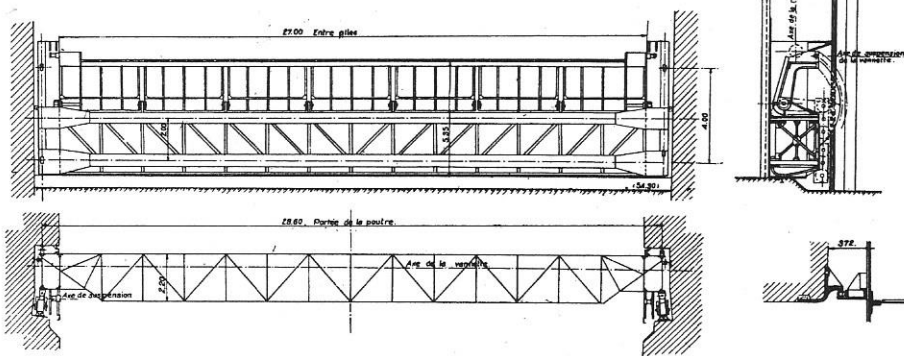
Vanne principale et disposition des maîtresses poutres. A droite, coupe de la vanne.
